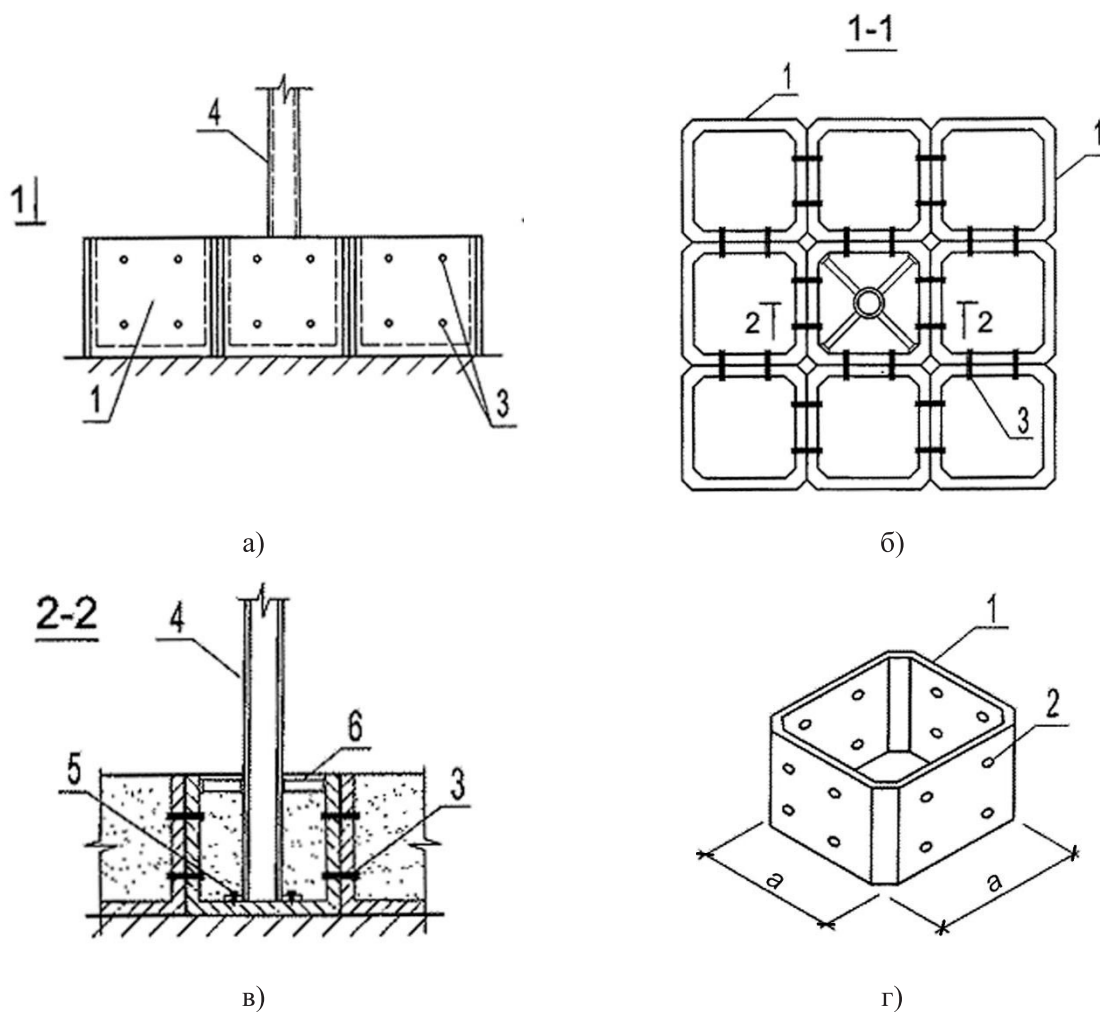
Сборно-разборный фундамент под опору: а – общий вид; б – вид сверху, разрез 1-1; в – разрез 2-2; г – аксонометрия железобетонного блока в виде полой квадратной призмы с размерами дна «а».
